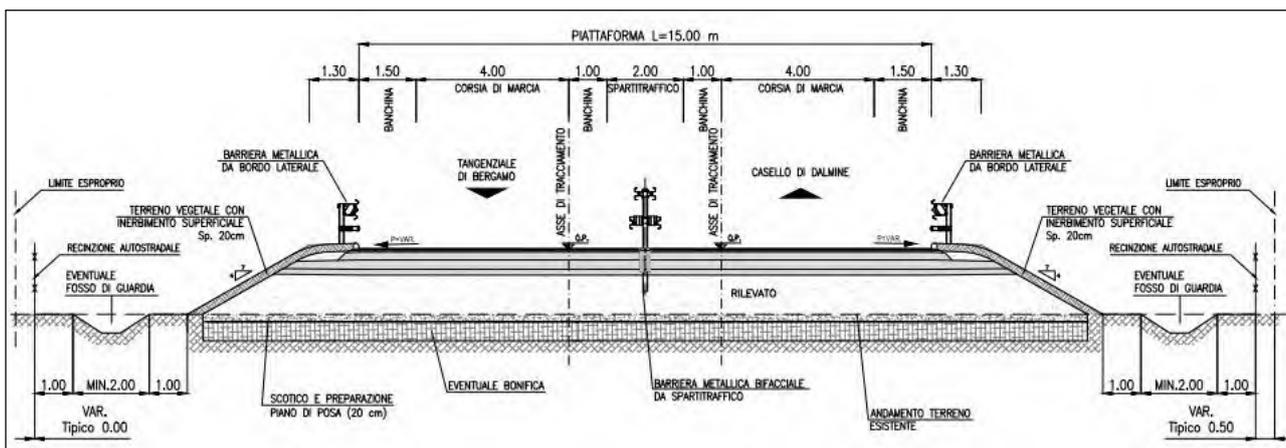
Sezione tipo rampa bidirezionale a 2 corsie
